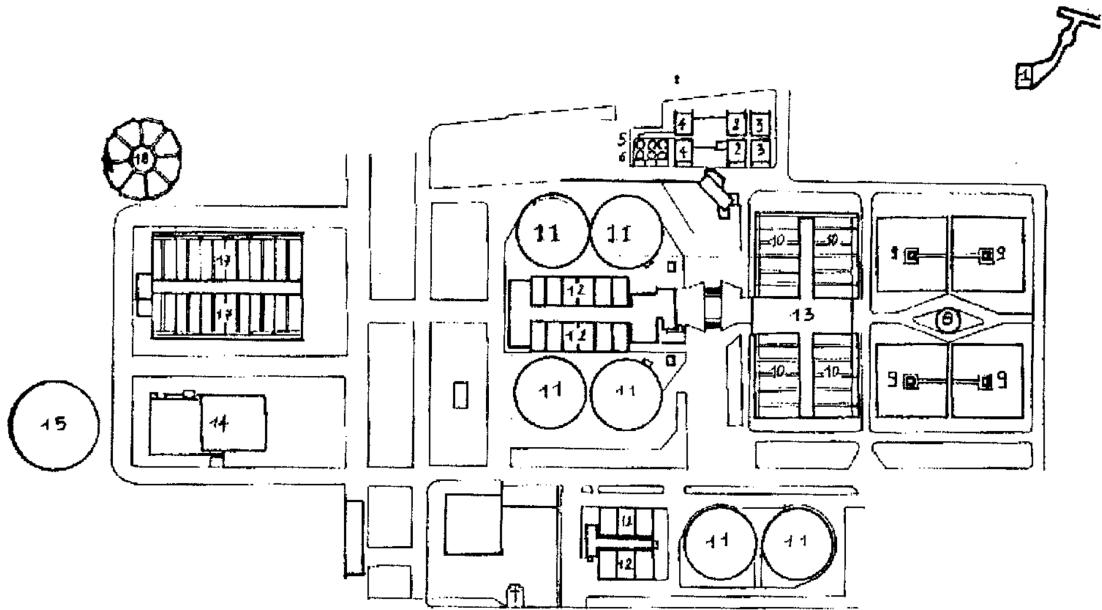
Pianta dell'impianto di potabilizzazione dell'Anconella.
